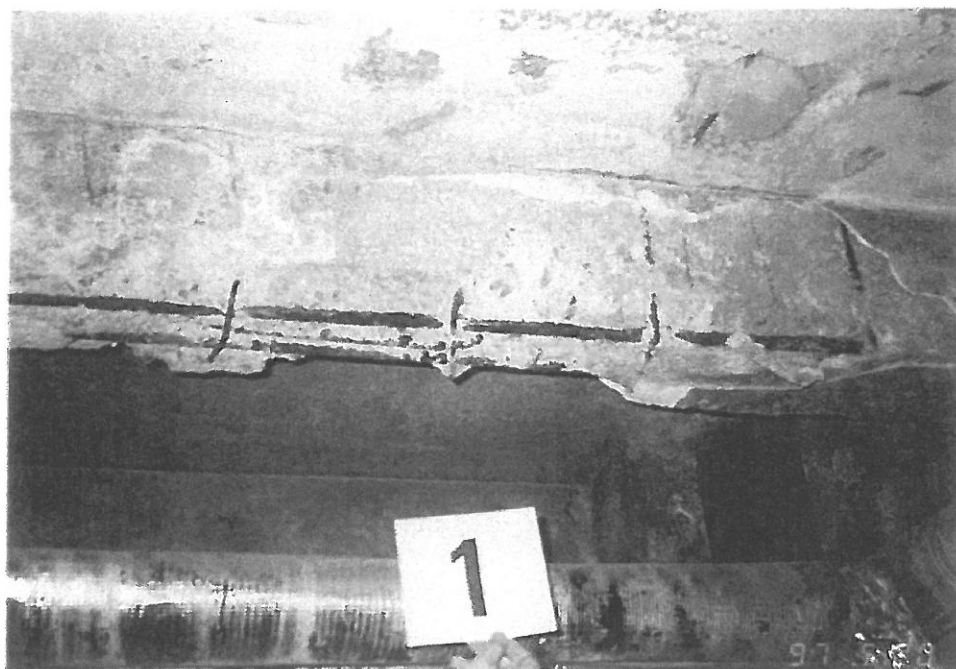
1. PP – žebet trám v kotelně .Výztuž i krycí betonová vrstva jsou silně narušeny korozí .
